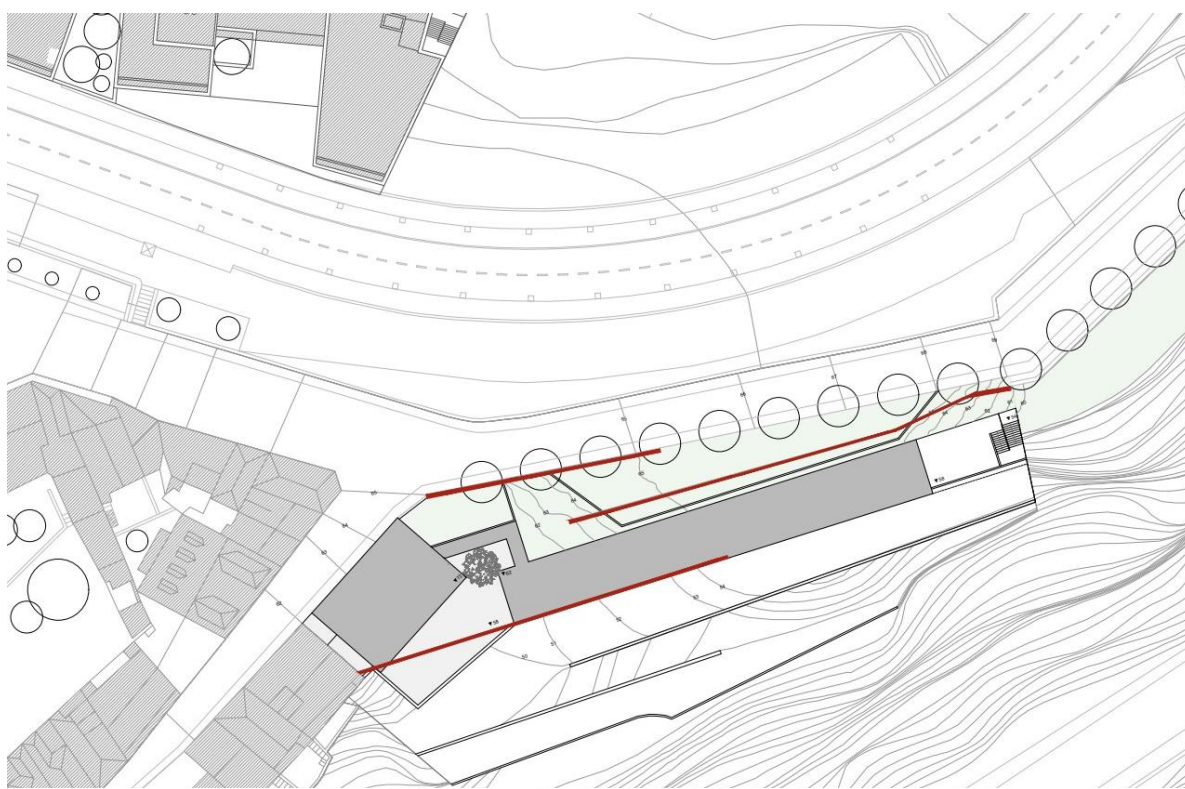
Planta de Implantação do Projeto V com os muros pré-existentes (Fonte: Autor)
